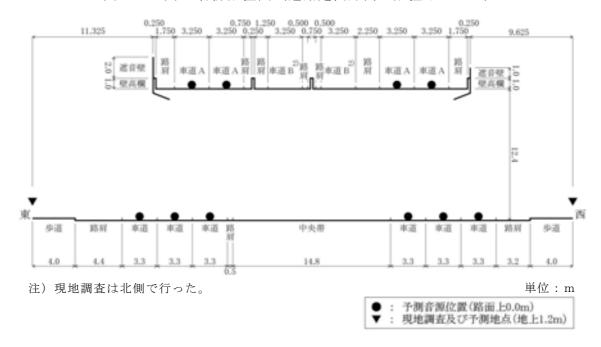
(2) 音源配置図 (道路断面方向の配置イメージ: No. 6 の例)
